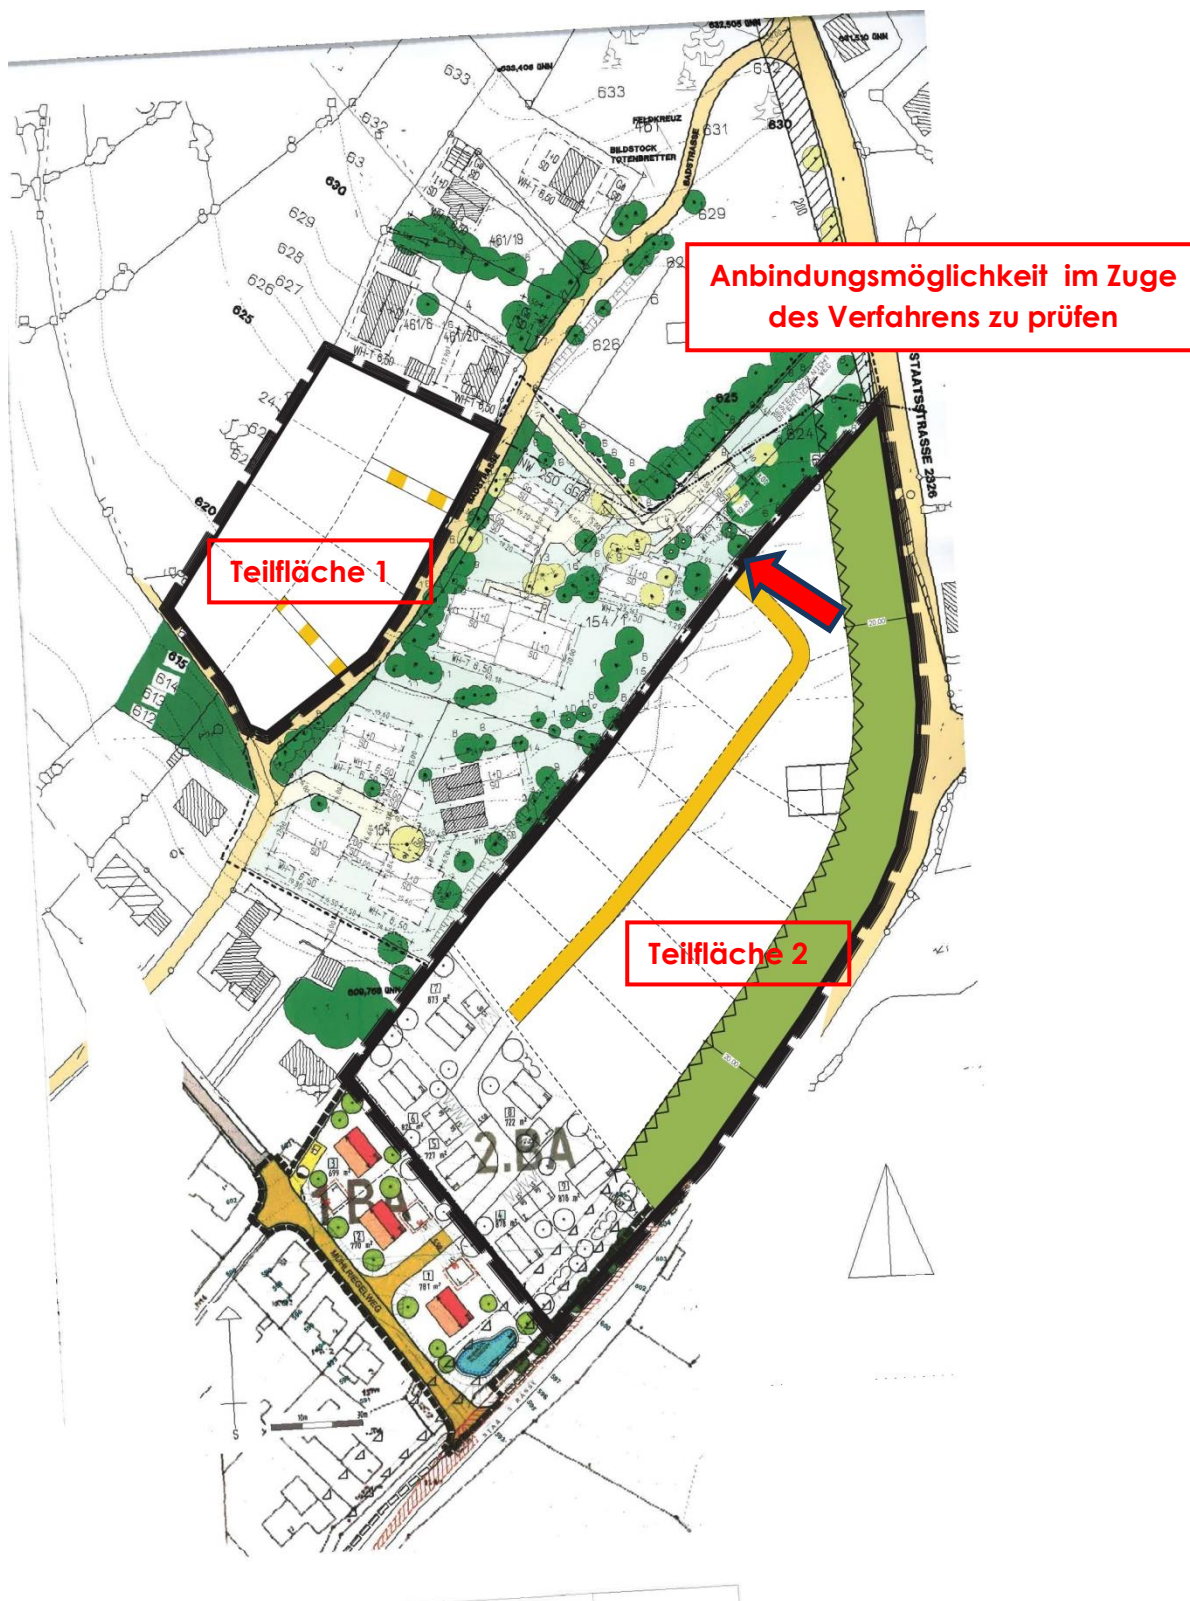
Mögliches Bebauungskonzept für den Standort 2 - Variante 2, maßstabslos
